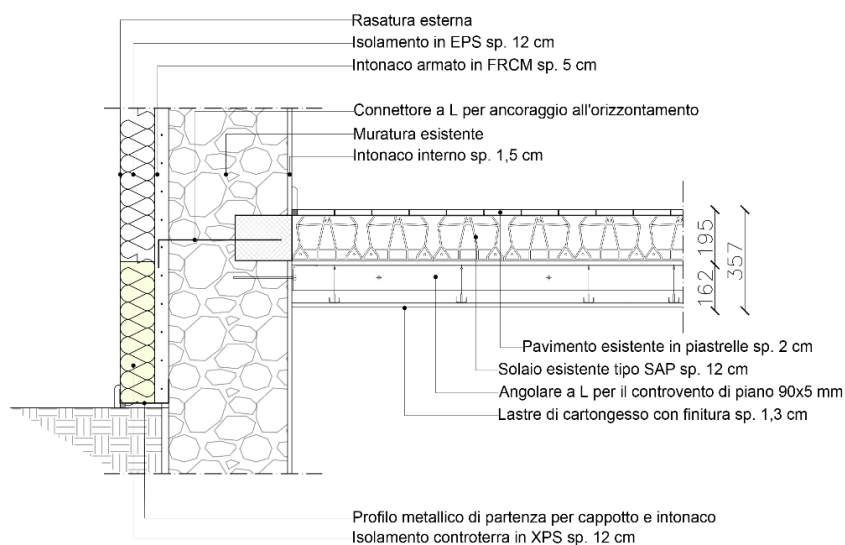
Dettaglio di sezione controterra del consolidamento strutturale e dell'intervento di retrofit energetico della muratura.
